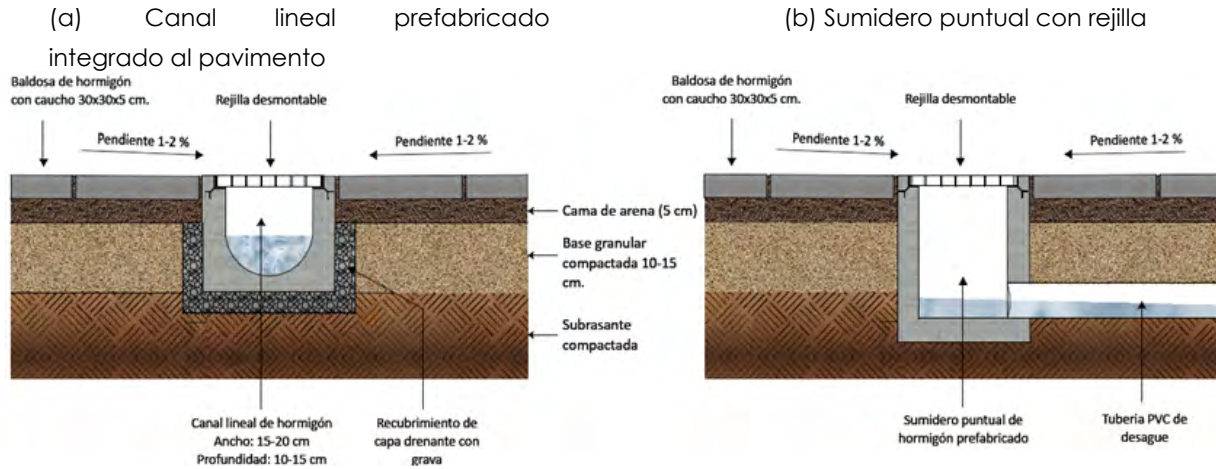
Soluciones de drenaje pluvial: (a) canal lineal prefabricado con rejilla desmontable integrado al pavimento; (b) sumidero puntual con rejilla en punto bajo.
